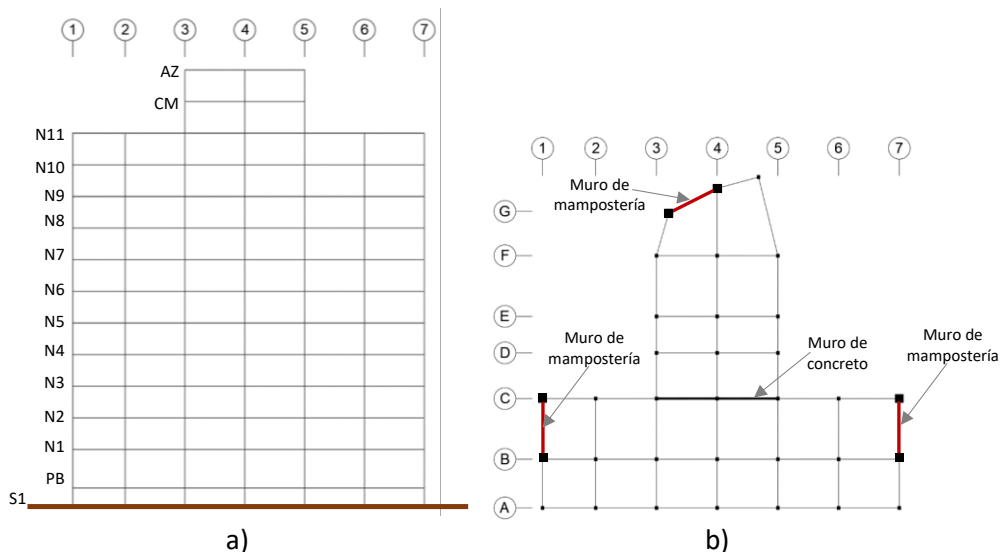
Vistas generales del edificio estudiado: (a) Elevación Eje A y (b) Vista en planta
